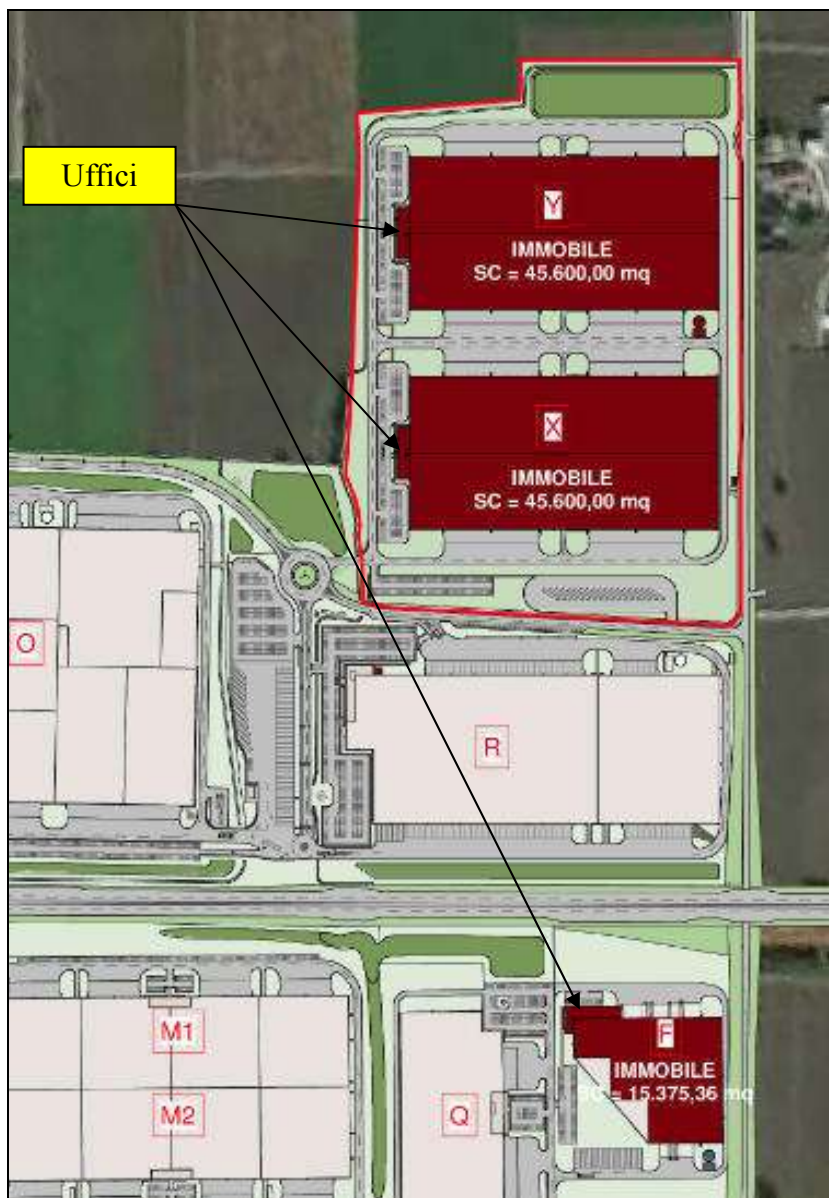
Pianta nuovo insediamento in progetto (in rosso)
